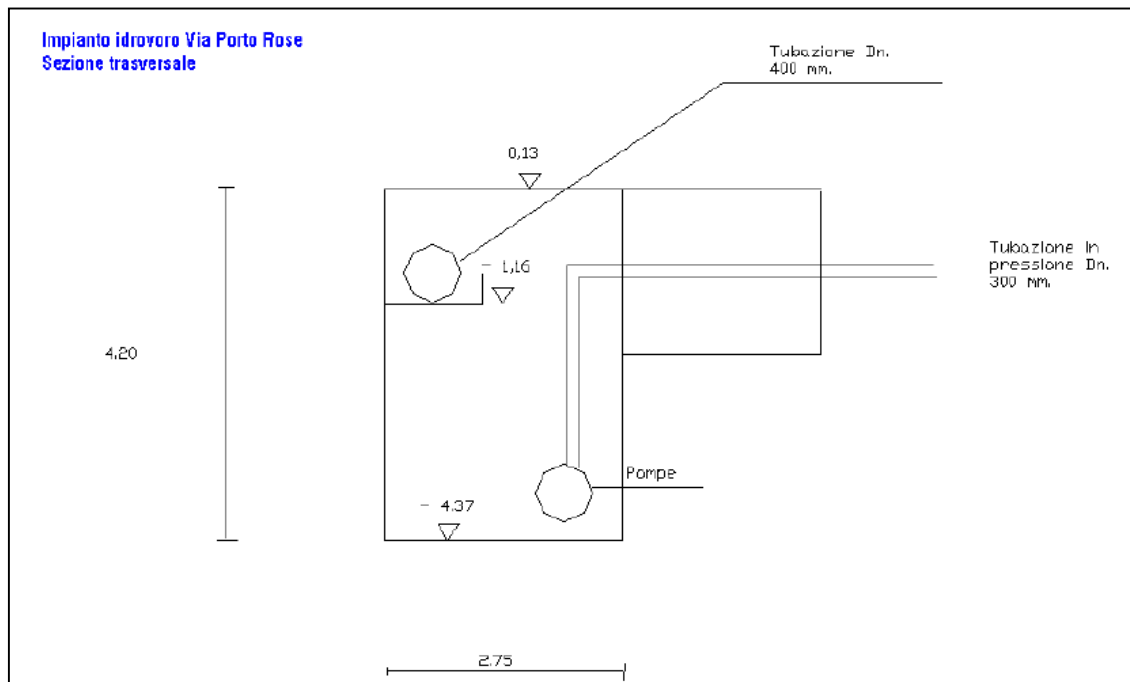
Sezione trasversale Impianto Idrovoro Via Porto Rose
